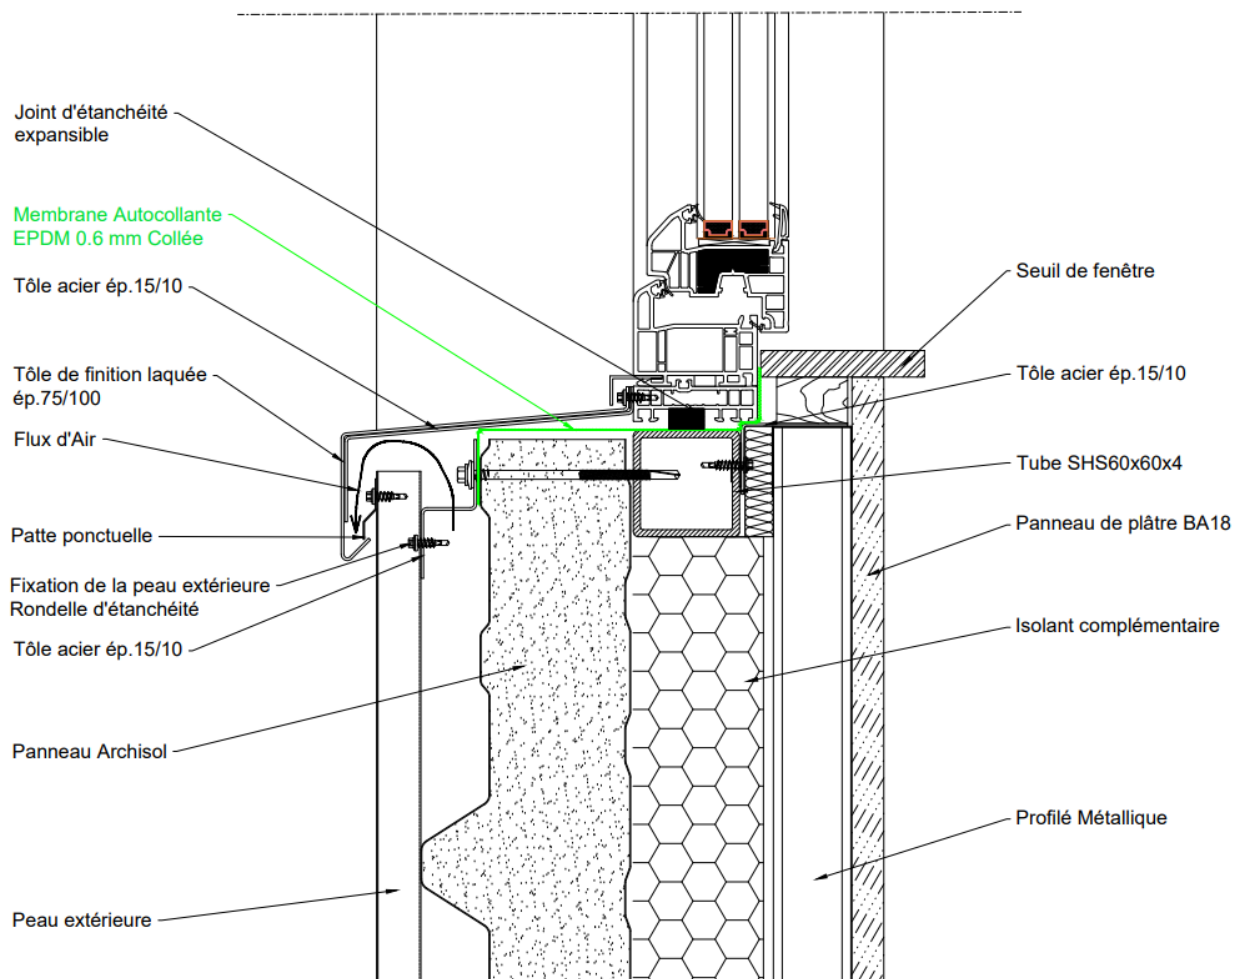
Coupe verticale sur la jonction seuil -D2B Archisol - Pose directe.
